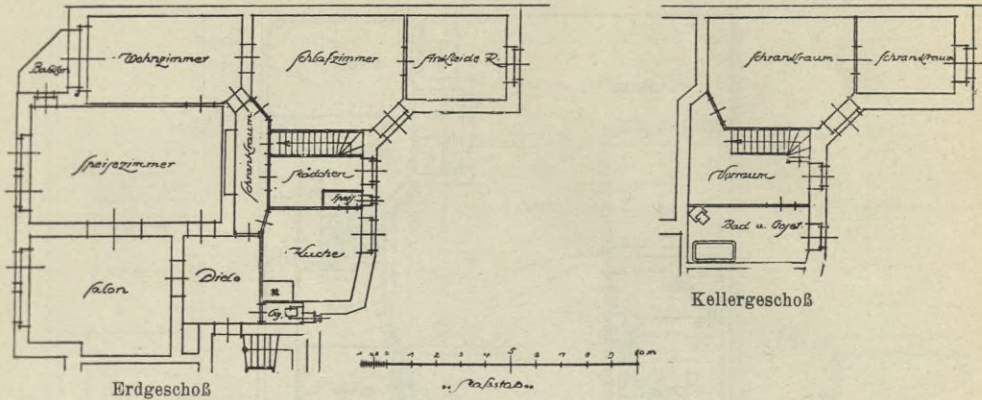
Grundriß einer Wohnung im Erdgeschoß mit Fortsetzung im Keller
